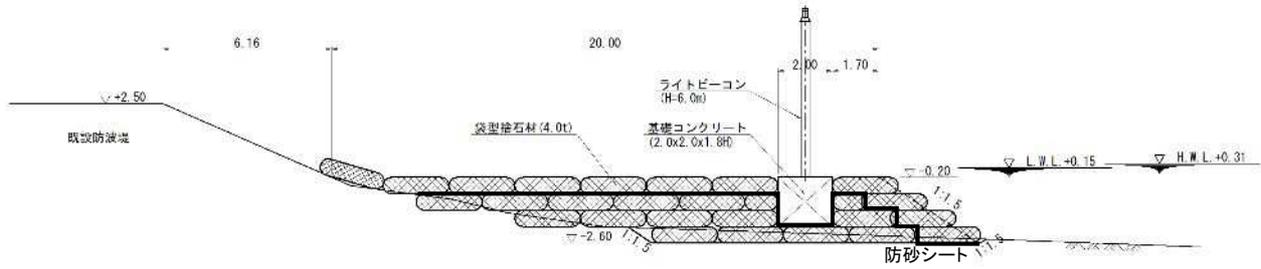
(2) 潜堤本體(暫定時)の縦断面図
